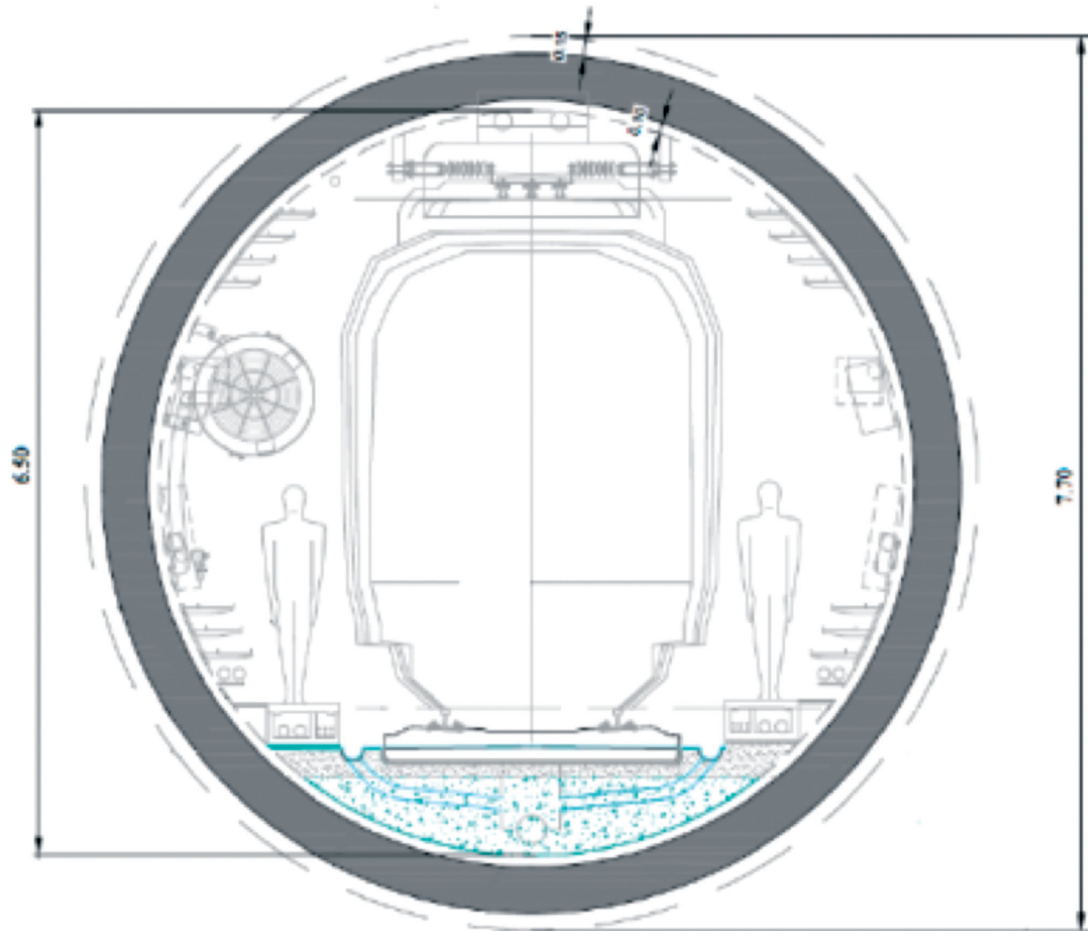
Illustration: coupes tunnel bitube ligne 17
